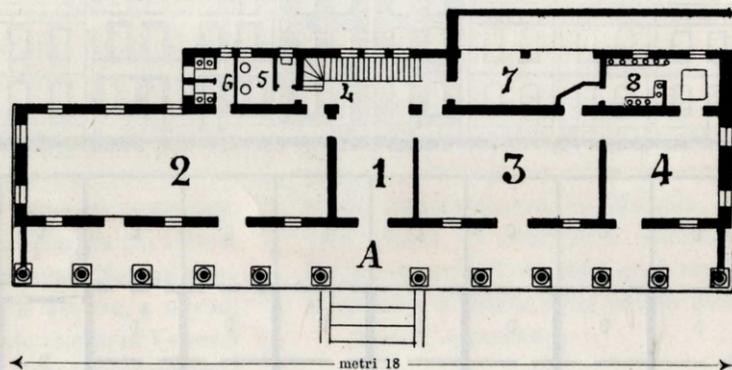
Pianta del piano terreno (Scala di 1:200).
